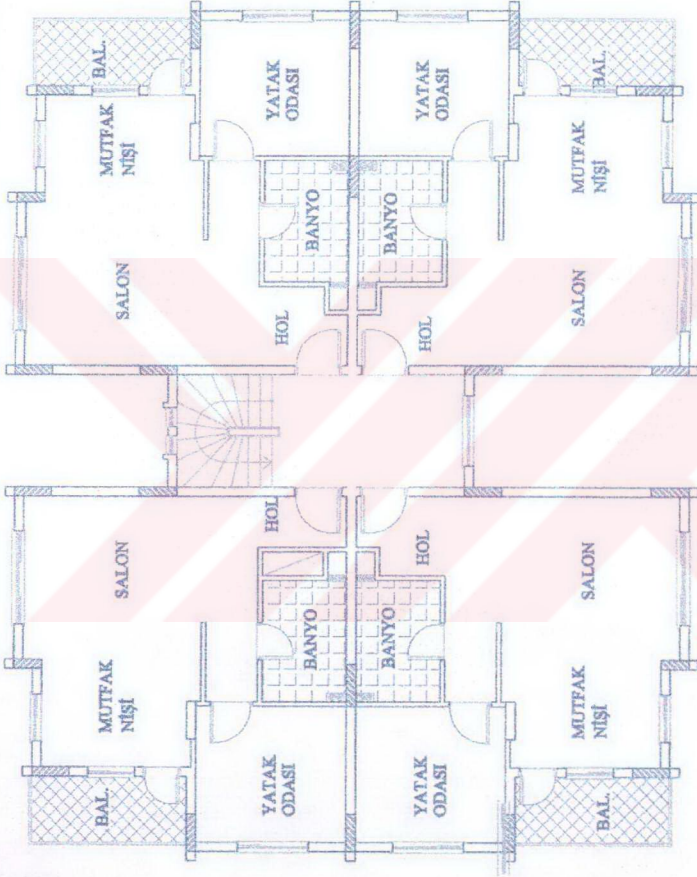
Yeni Barışkent A Tipi normal kat planı
